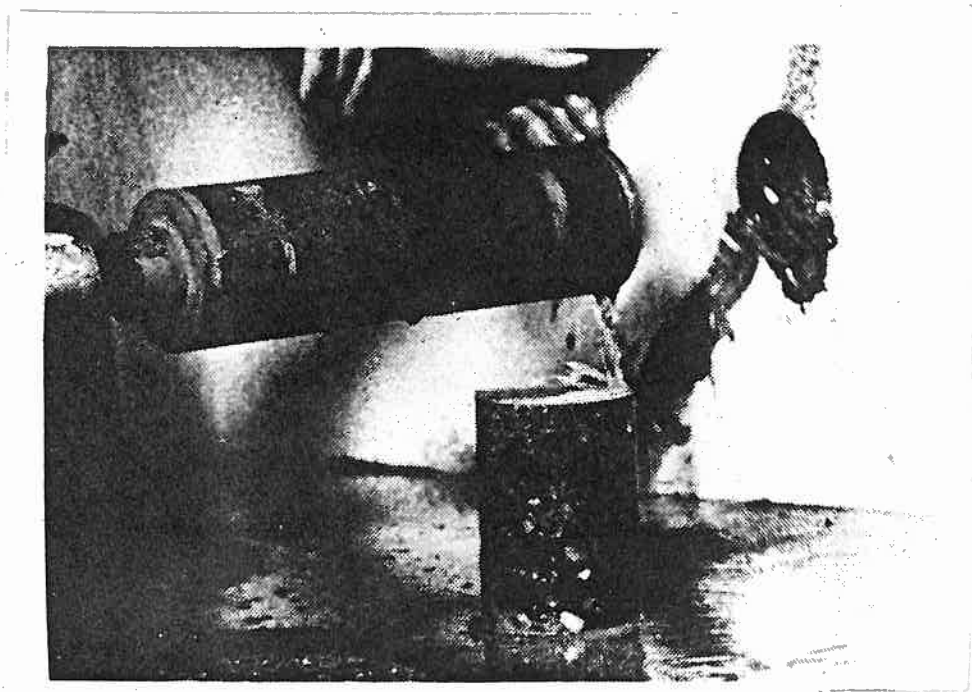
Extracção de uma amostra de uma junta de ligação
